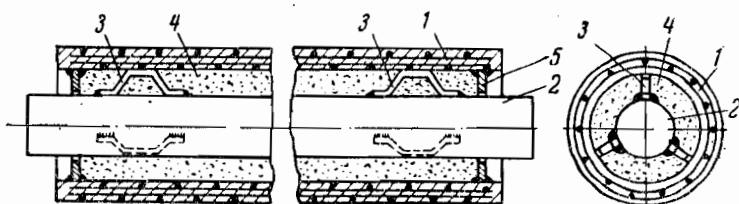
Теплопровод конструкции ВТИ — Мосэнерго в железобетонных центрифугированных трубах.
